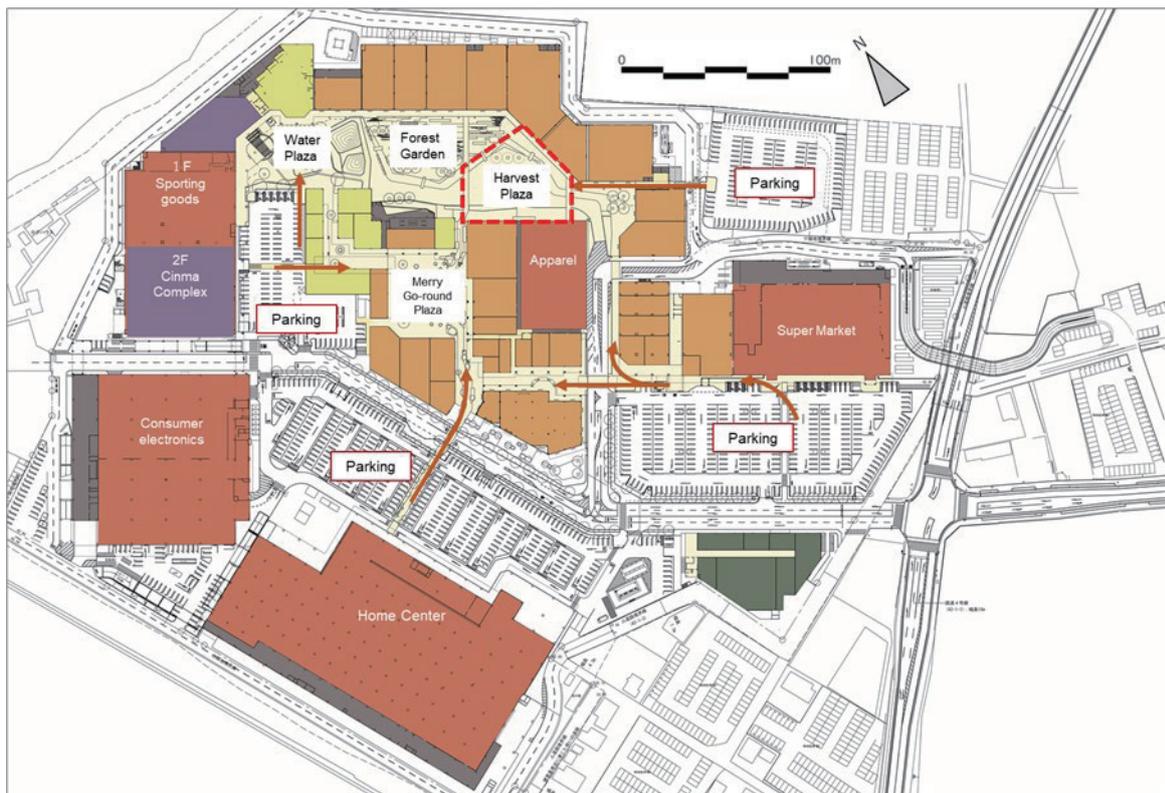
おやまゆうえんハーヴェストウォーク配置図・1階平面図
